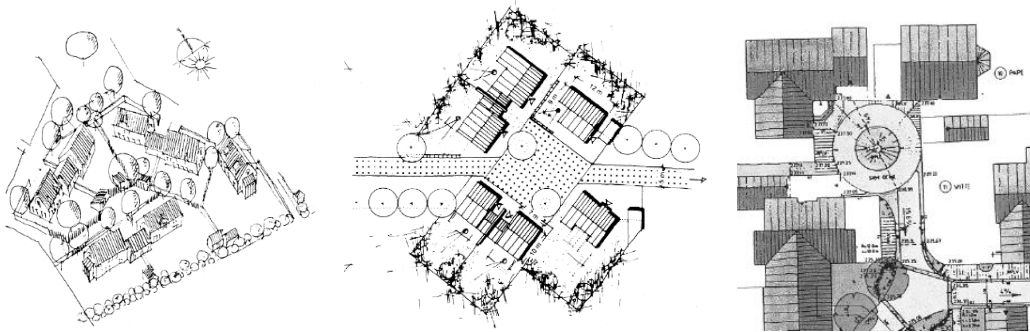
Beispiele für gruppierte Bauformen im ländlichen Raum. Quelle: „Grundlagen zur Ortsplanung“, TU Kaiserslautern 2004
